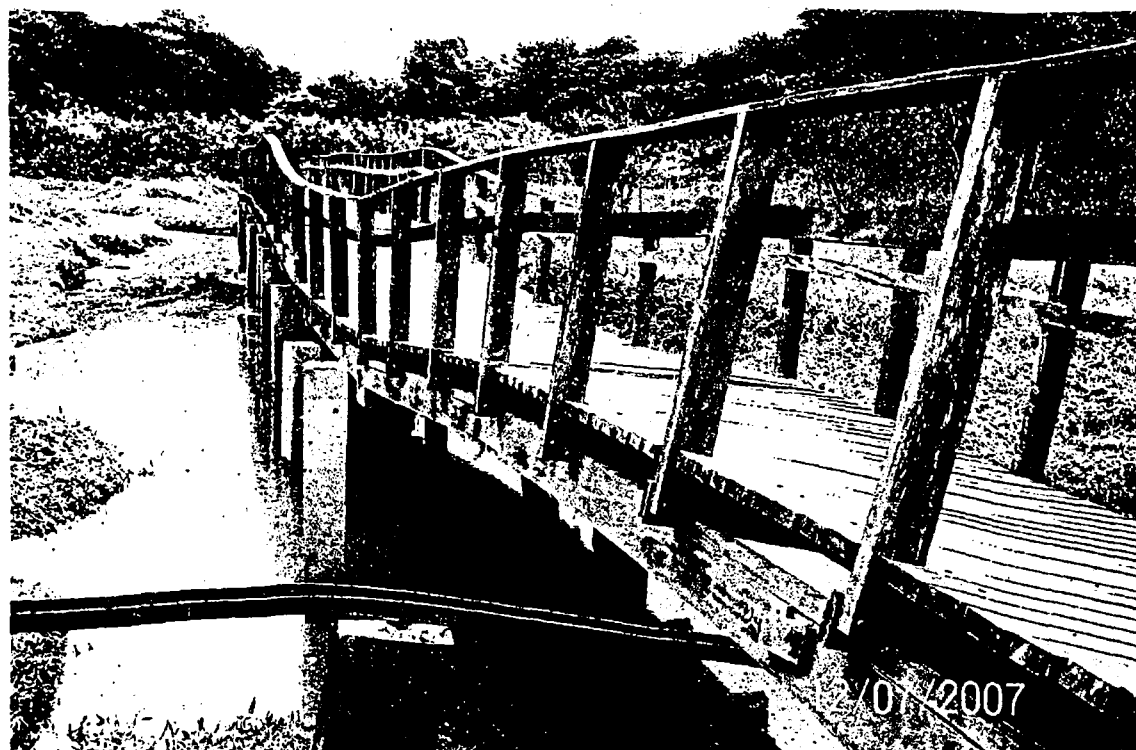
Outra vista da passarela de madeira colapsada, em trecho sobre água. Note-se que os pilares de concreto sofreram rotação horizontal, e também não apresentam qualquer amarração com a superestrutura. Foto obtida em 12/07/2007.
